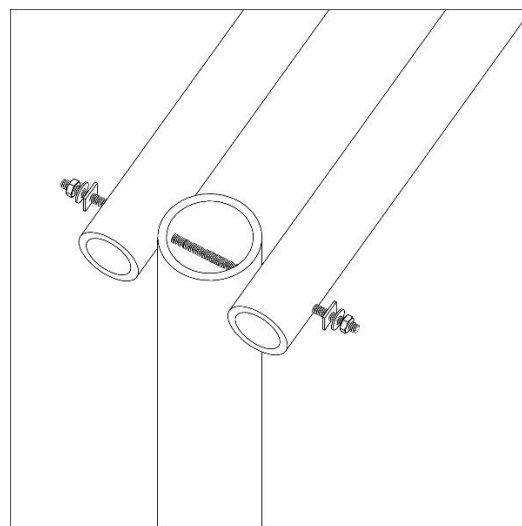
Schema connessione trasversale a taglio retto tipo CON 1.
